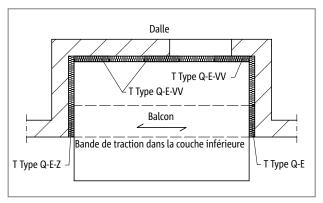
Schöck Isokorb® T Type Q-E, Q-E-Z et Q-E-VV : Loggia soutenue sur trois côtés avec bande de traction
